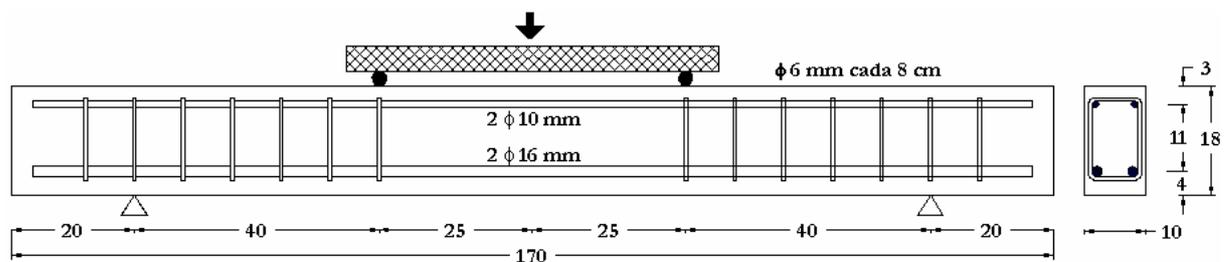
Detalhamento da viga de Lim e Oh (1999) com 50% da área de armadura necessária para o reforço ao corte (vigas S0.50-0, S0.50-1 e S0.50-2).
